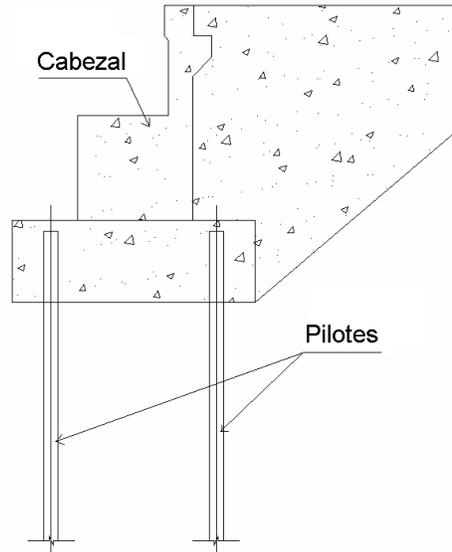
Fundación tipo cabezal sobre de pilotes
